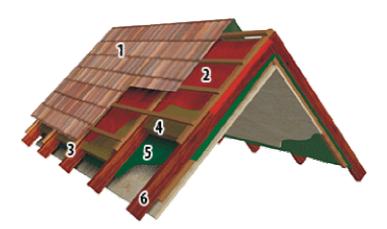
Применение материалов Изоспан в конструкциях утепленной кровли
